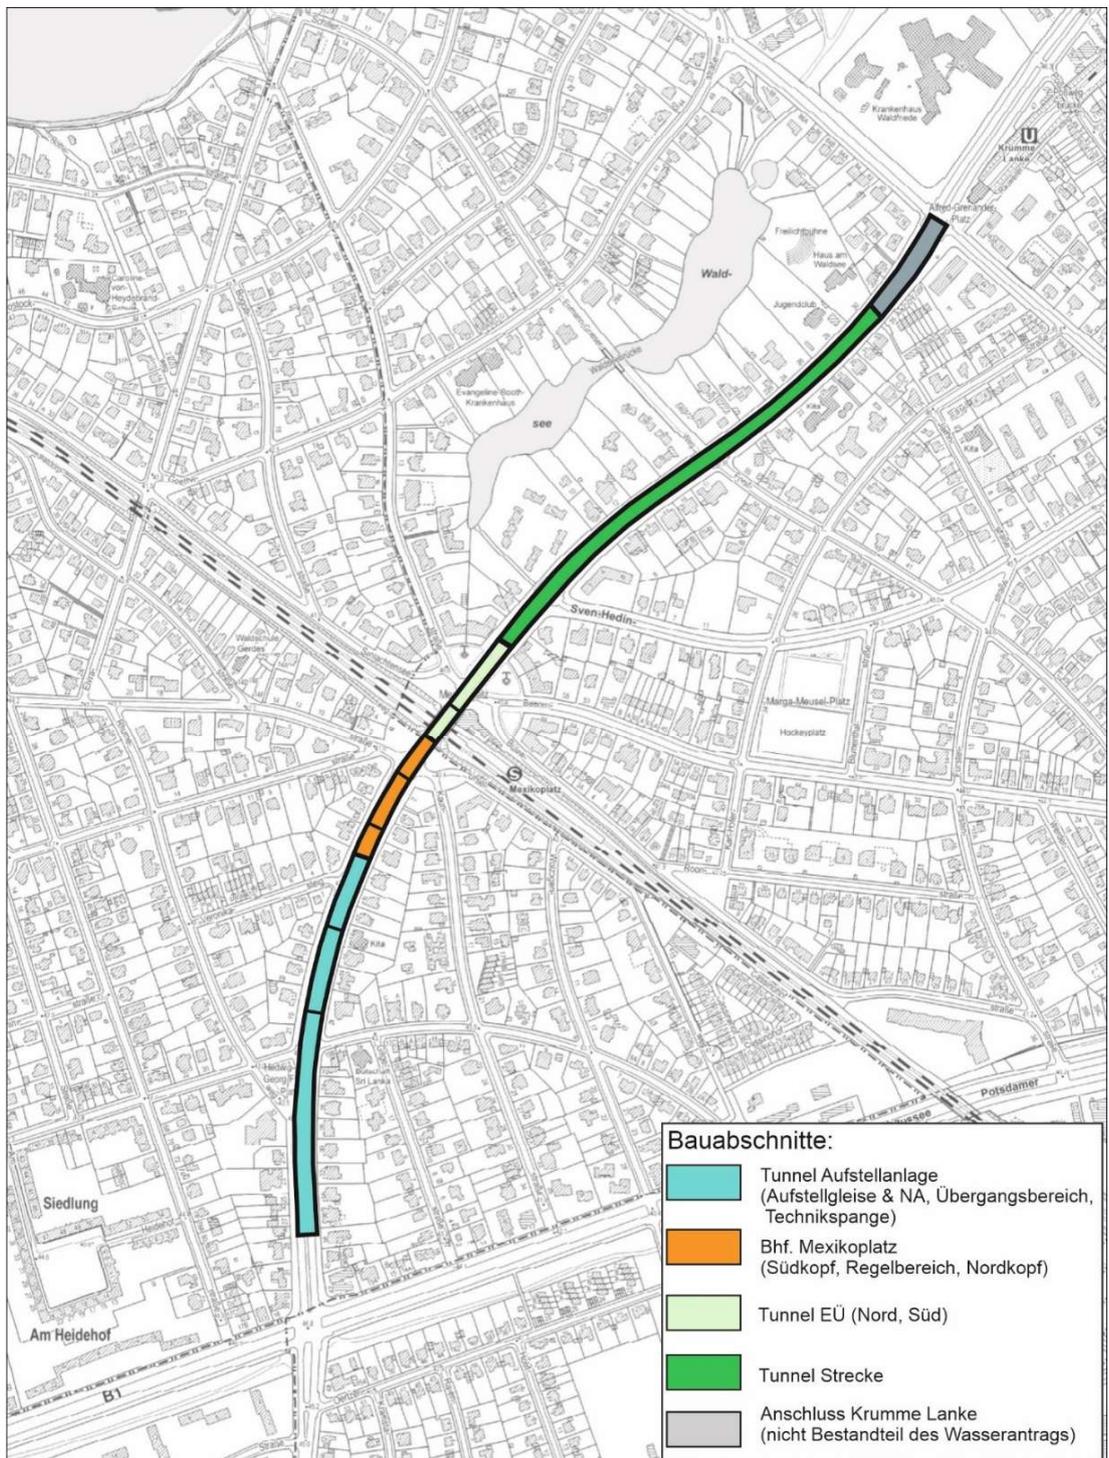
Lageplan, Bauabschnitte (Quelle: Geodatenportal Berlin/ Berlin-Zoom (SW-Ausgabe))
